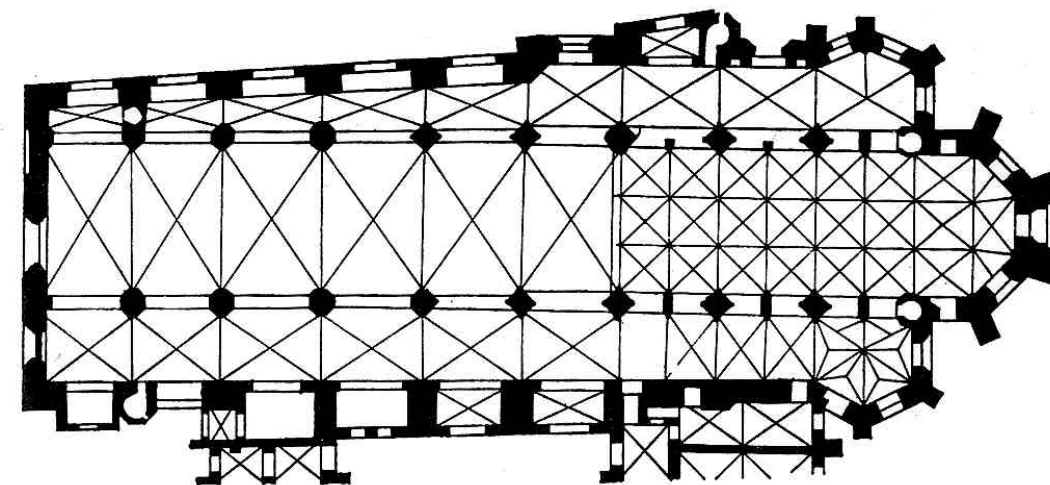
Grundriss der Kirche und des Klosters
